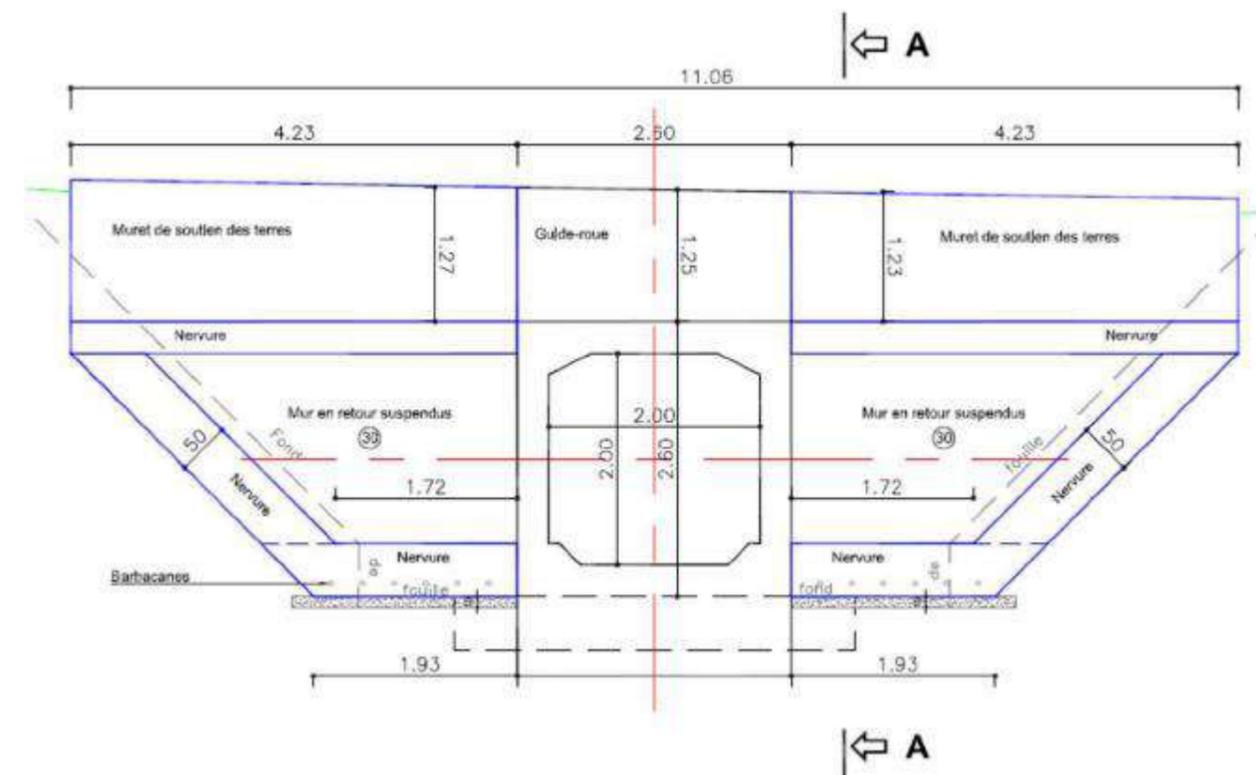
Profil travers sur l'ouvrage (source : plan APD, ITCE, aout 2023).
